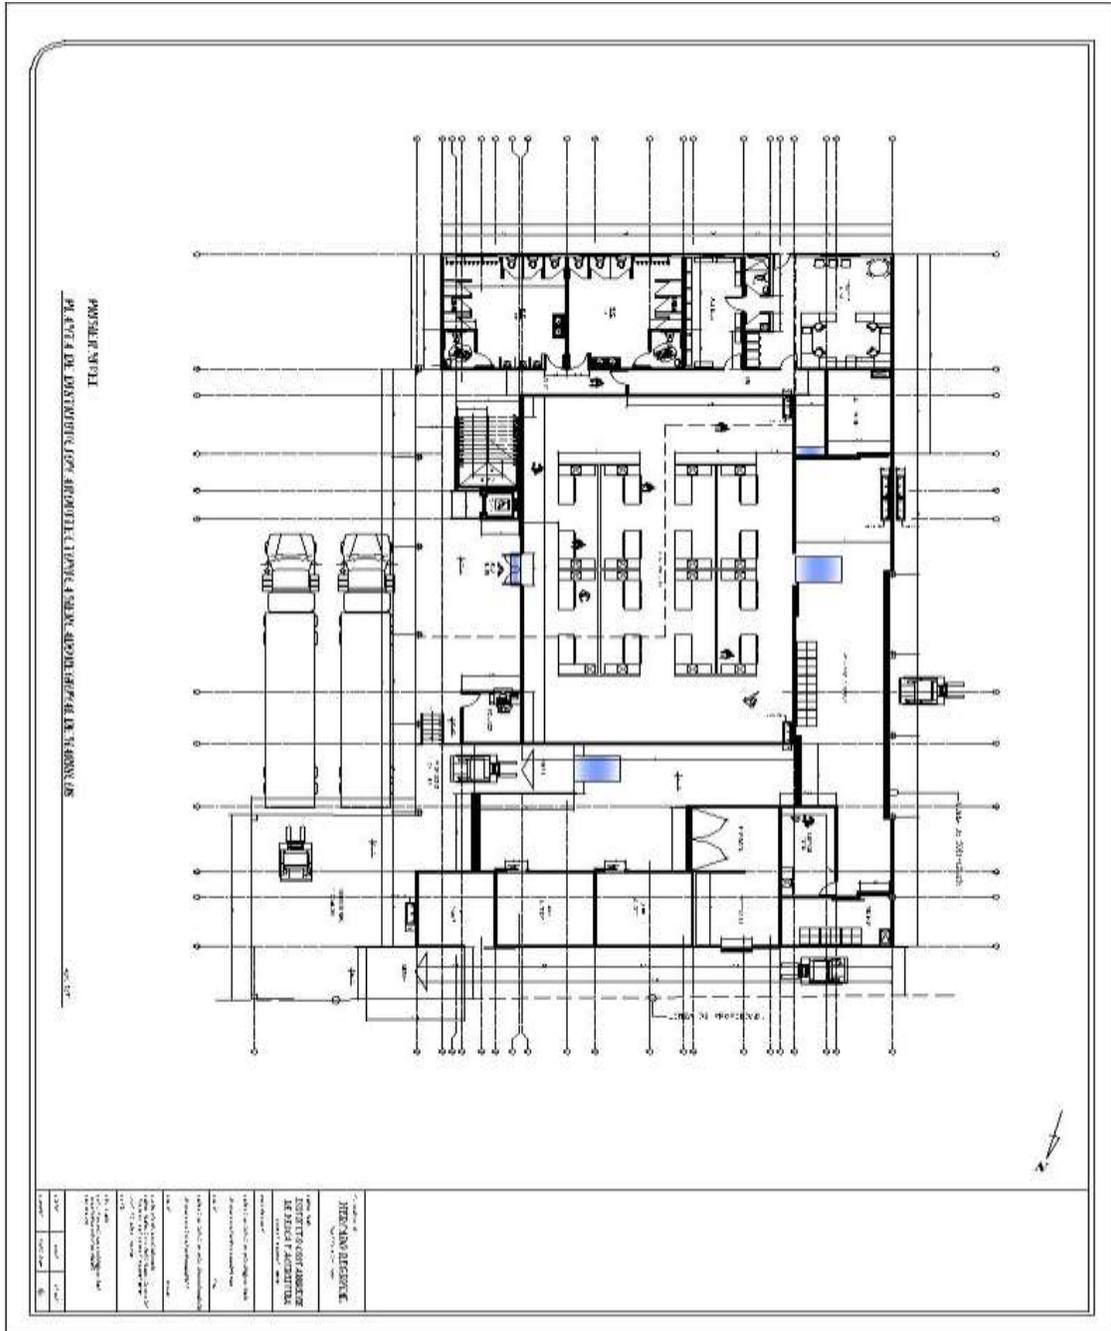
Primer nivel, Planta de Distribución Arquitectónica Mercado
